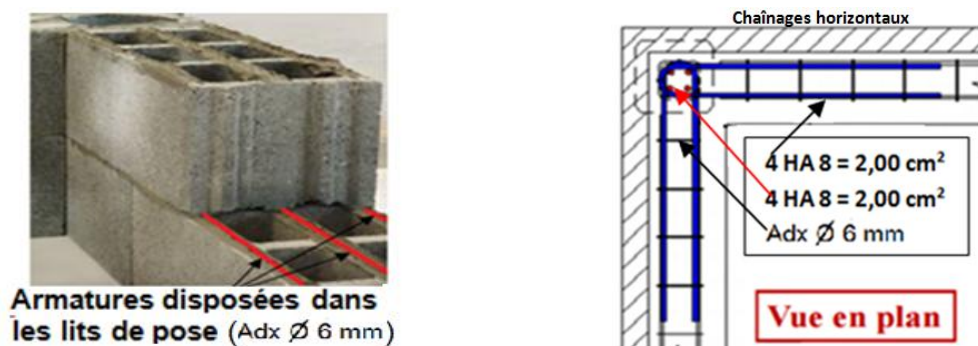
Dispositions constructives de renforcement parasismique dans les maçonneries armées
